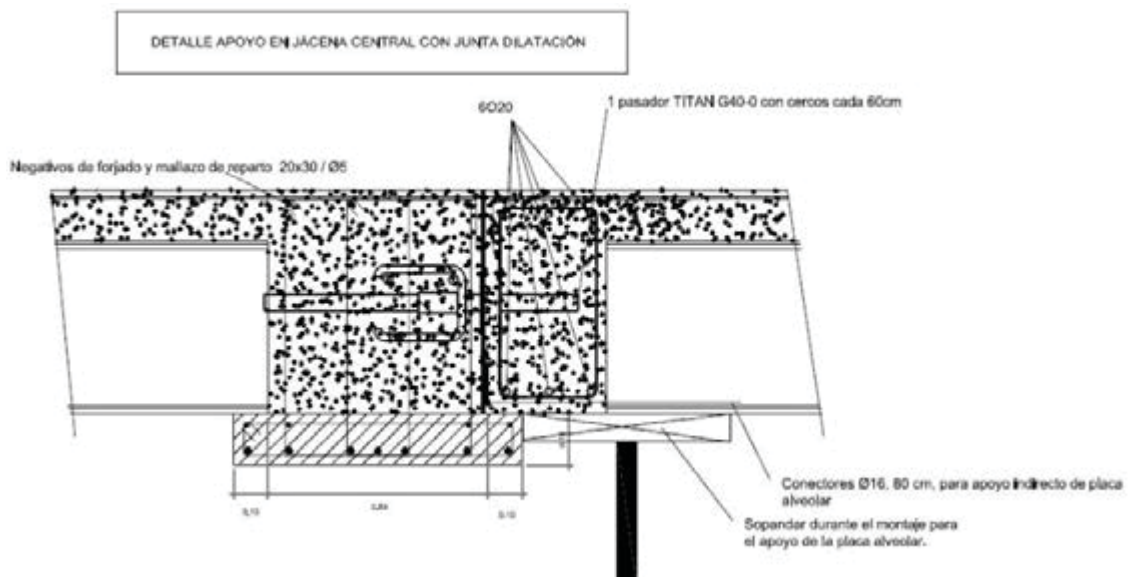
Projecte as built : detall junt dilatació sostre planta -1
